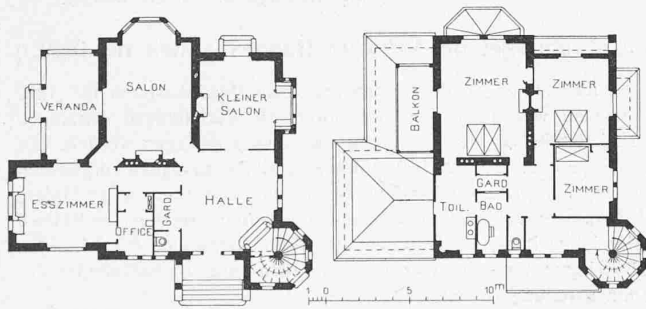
und 4. Grundrisse vom Erdgeschoss und I. Stock der Villa «Beau Chêne». — Masstab 1 : 400.
